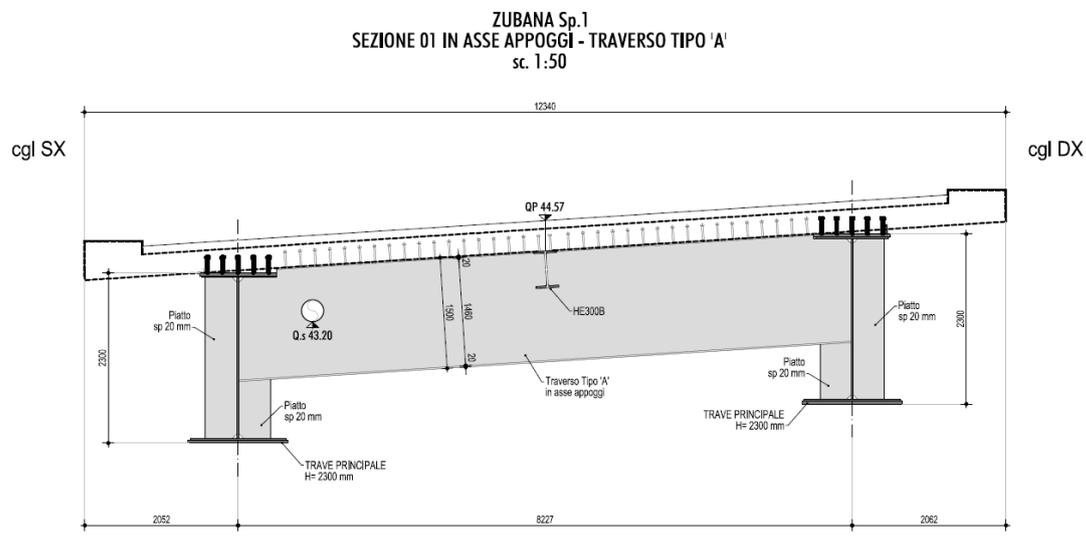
SEZIONE TRASVERSALE IMPALCATO SULLA SPALLA 1
